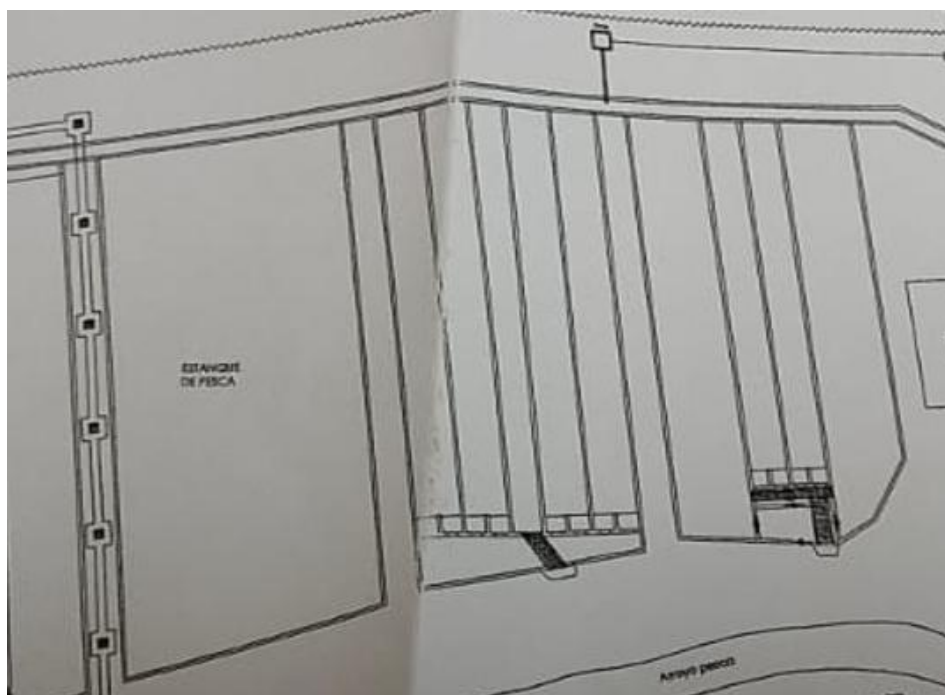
Plano de planta general de las baterías A y B y del estanque de pesca.
